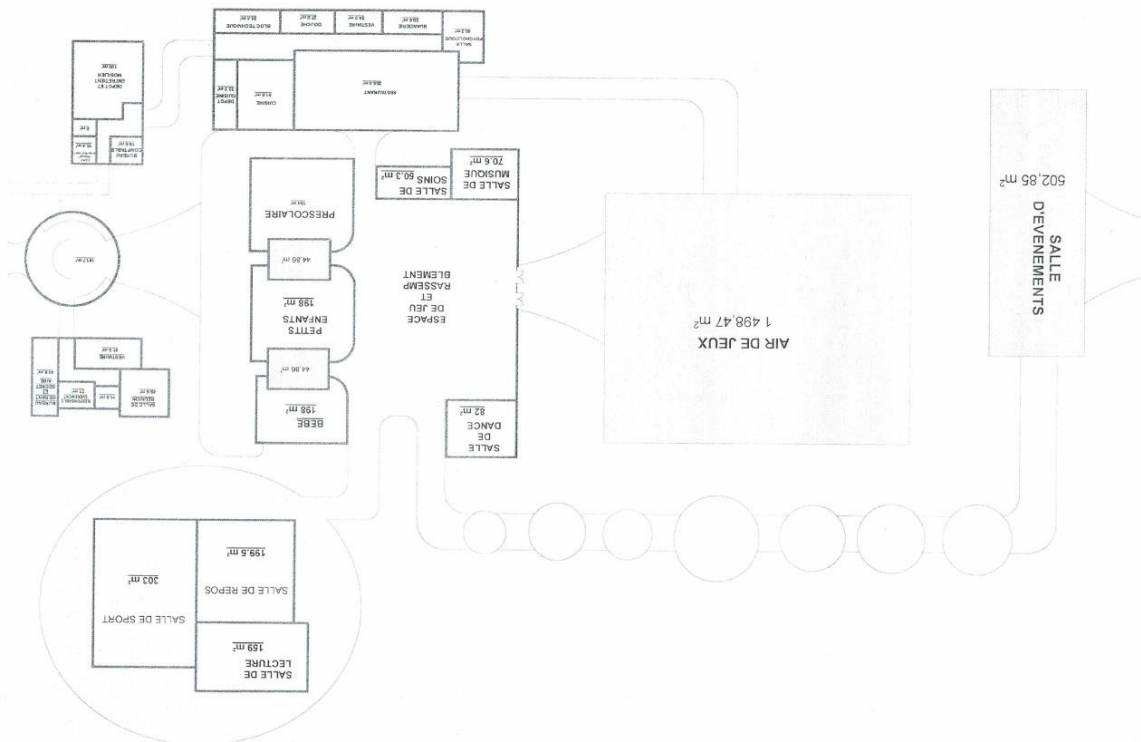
plan d'assemblage 1 /par l'auteur année 2021
